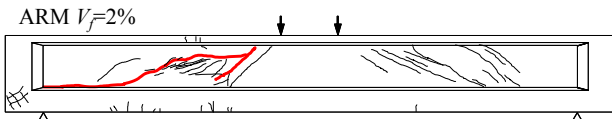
ARMを用いたUFGはりのひび割れ状況
